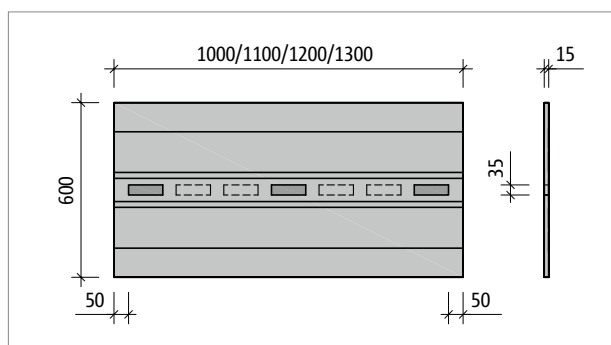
Tronsole® B-V1...-B600: Produktgrundriss
